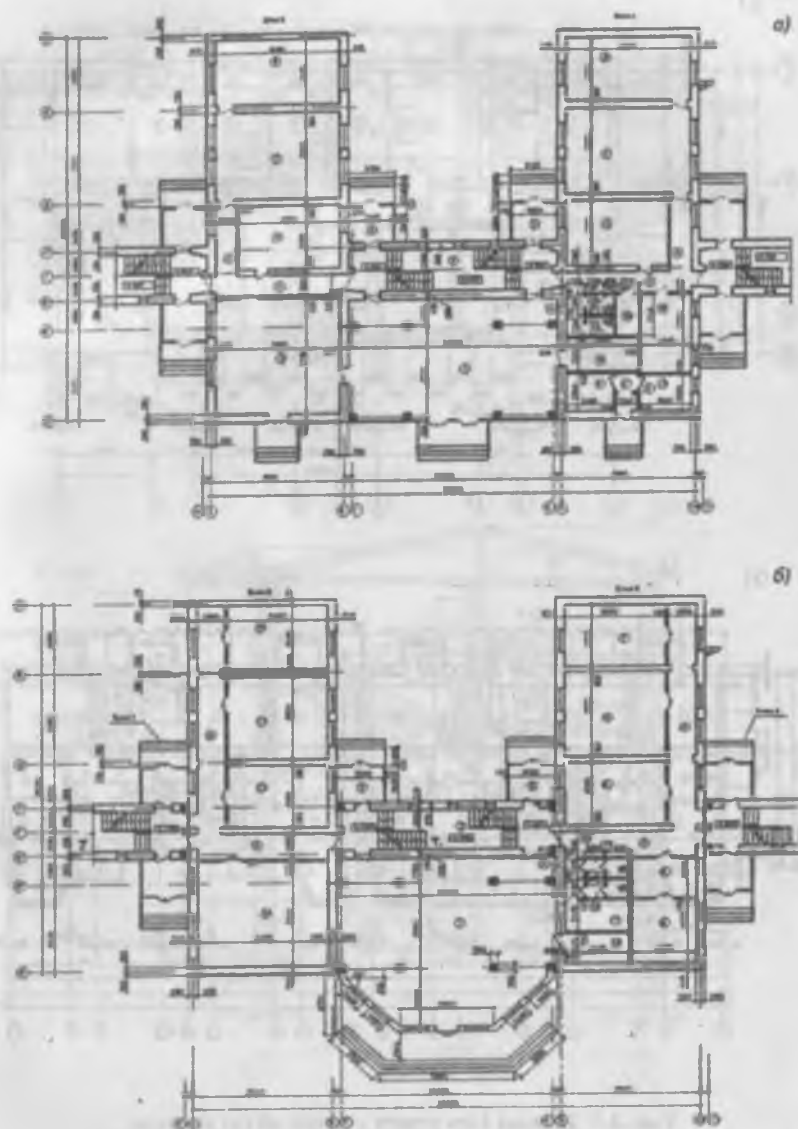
Планы 1-го этажа здания до (а) и после реконструкции (б).
